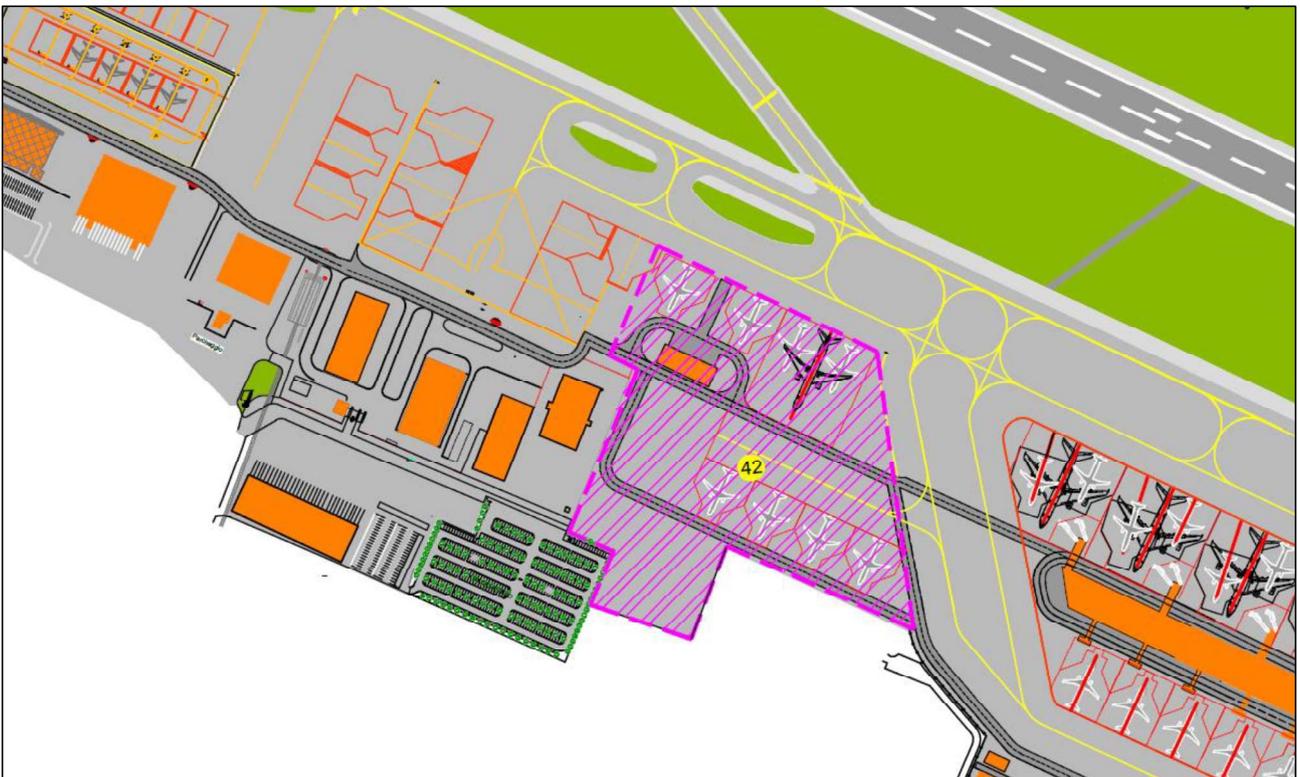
Estratto Master Plan – Ampliamento Apron 2
